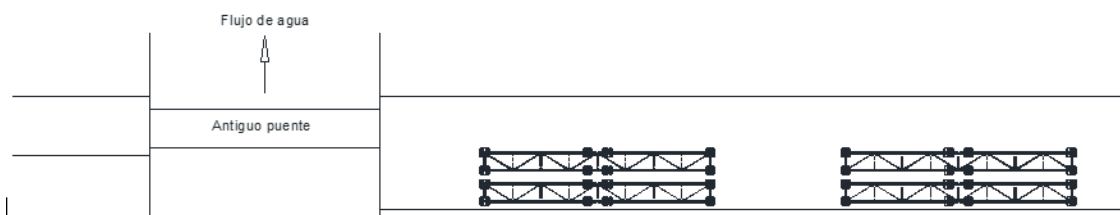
Construcción de las vigas metálicas a un costado de la vía existente
